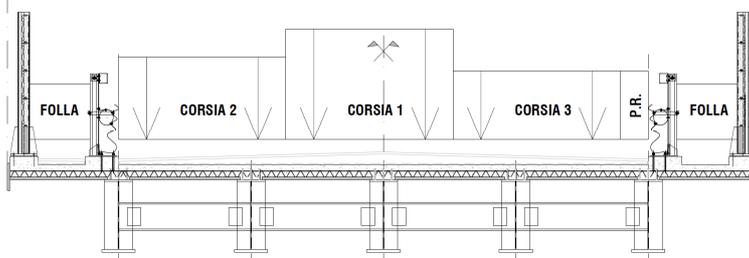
Disposizione dei carichi da traffico 3: massima flessione sull'impalcato (carichi centrati).
